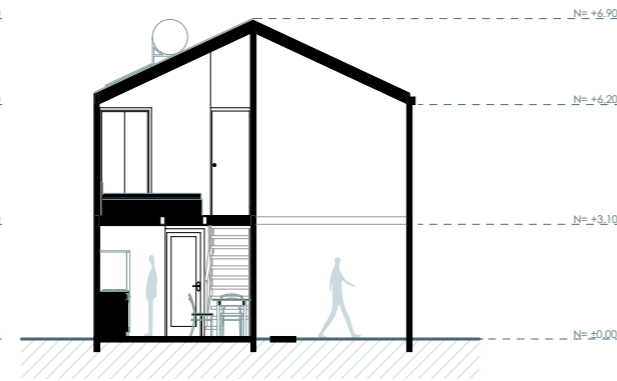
Sección A-A Villa Verde. Fuente: Autores, 2023
